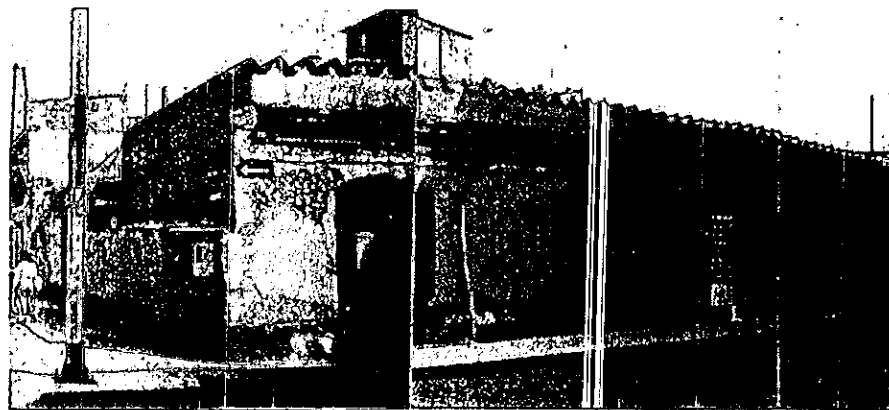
Construcciones de este tipo es posible encontrar aun en el centro de la ciudad.
